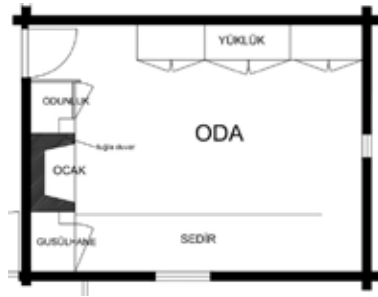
İmamgöl Evi Yaşam Katı Planı
